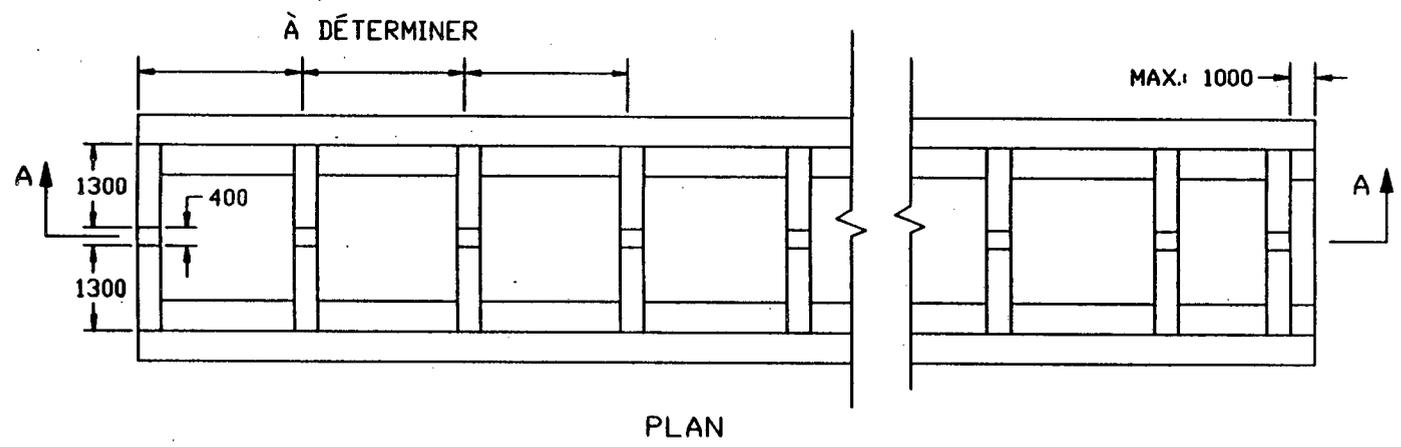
DETAIL DU MUR PARAFUILLE A DETERMINER SOUS LA SEMELLE DU MUR DE SOUTÈNEMENT
